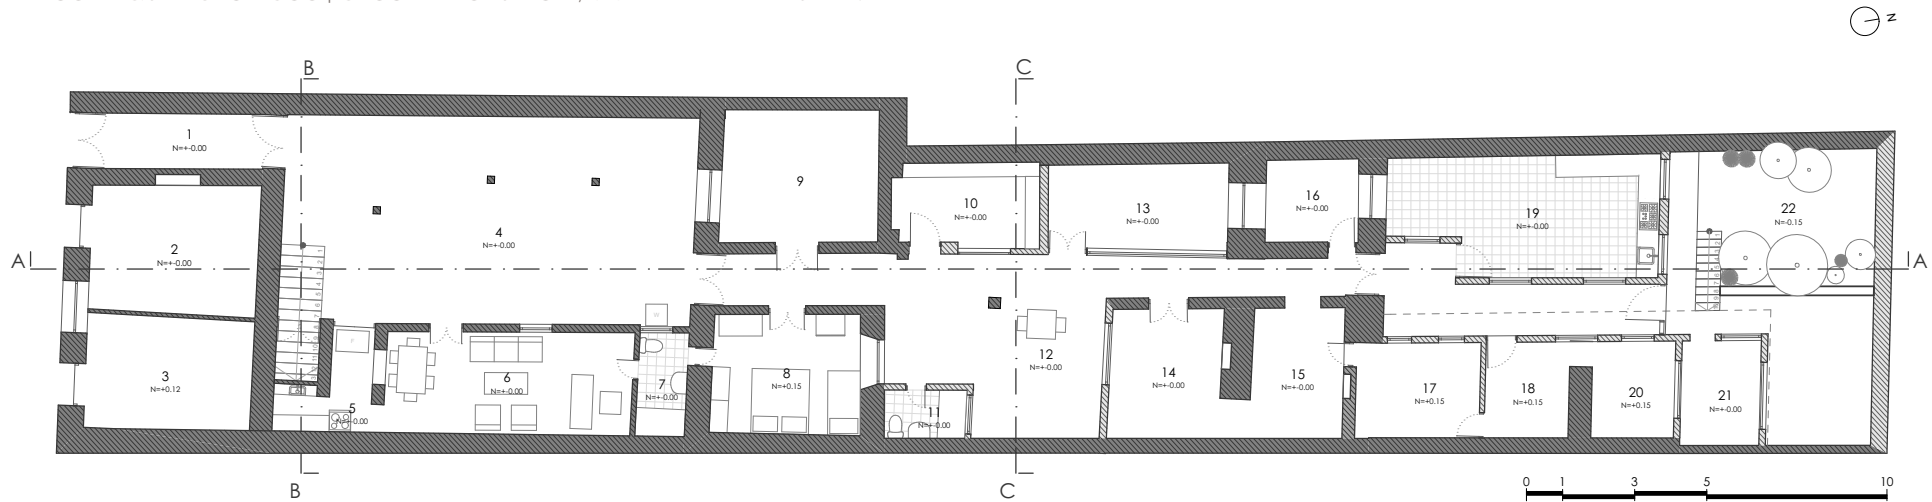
Planta Baja | Caso de estudio 2, Vivienda Berrezueta.
